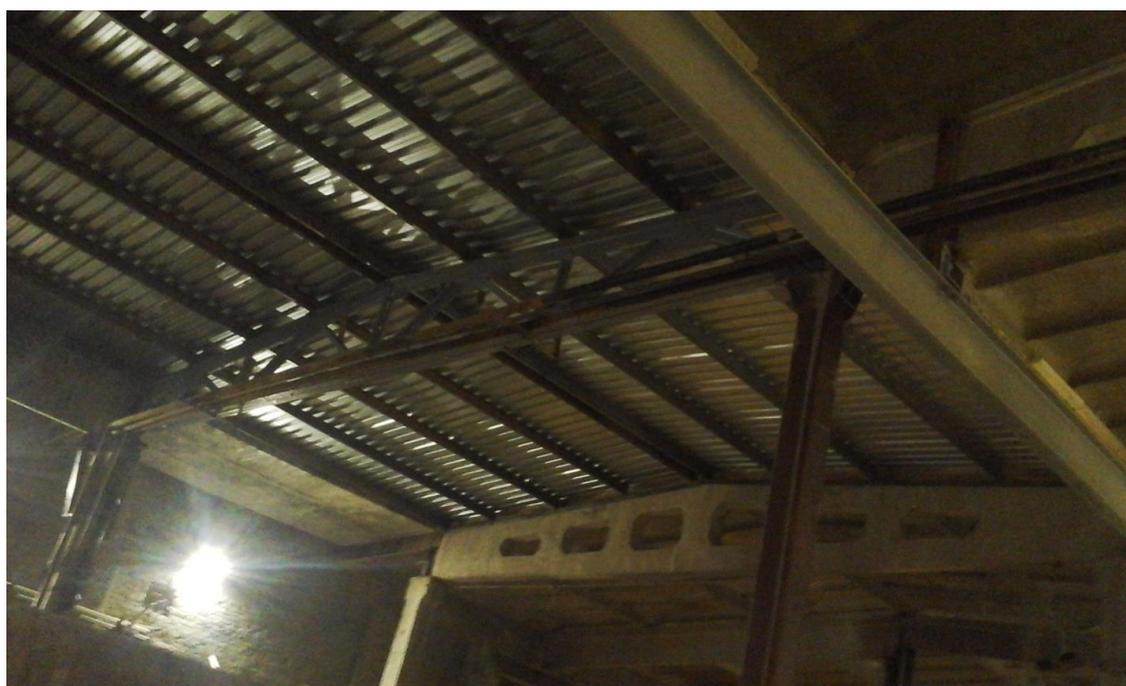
Замена аварийной железобетонной стропильной балки, стойки и плит покрытия стальными конструкциями (ферма, прогоны, настил из профилированного листа)
